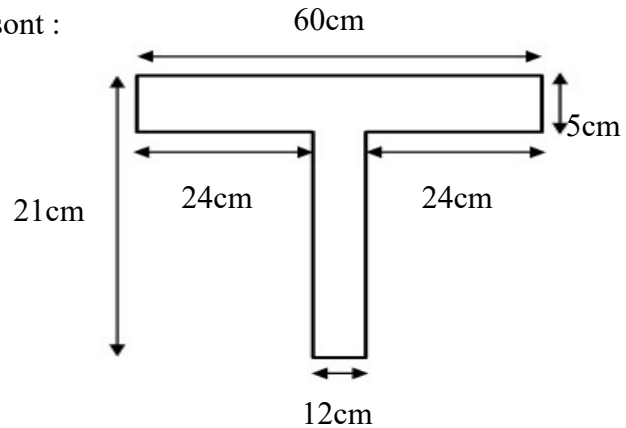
les dimensions adoptées pour les poutrelles.
